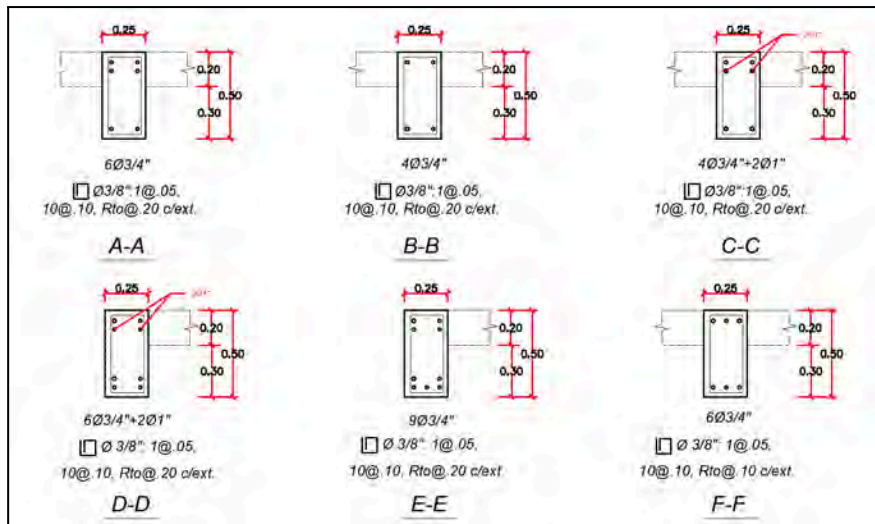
Diseño final viga V-22(Corte de las secciones).(Fuente:propia)
